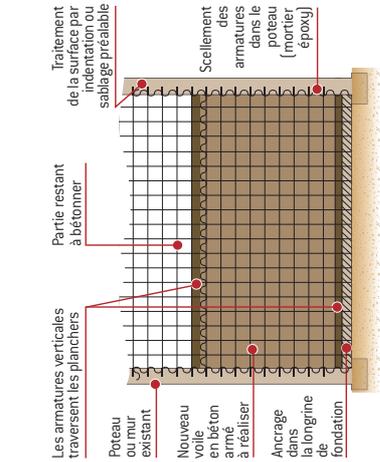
Exemple de renforcement du contreventement d'un bâtiment par création de murs nouveaux entre deux poteaux existants (élévation)
